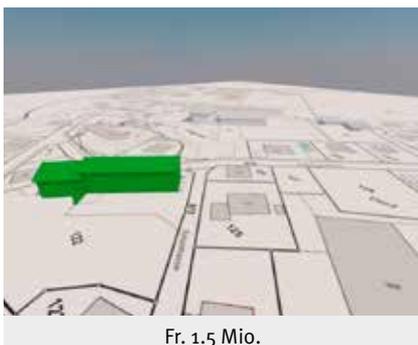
Situationsplan Niederhelfenschwil, inkl. Flächenangaben
